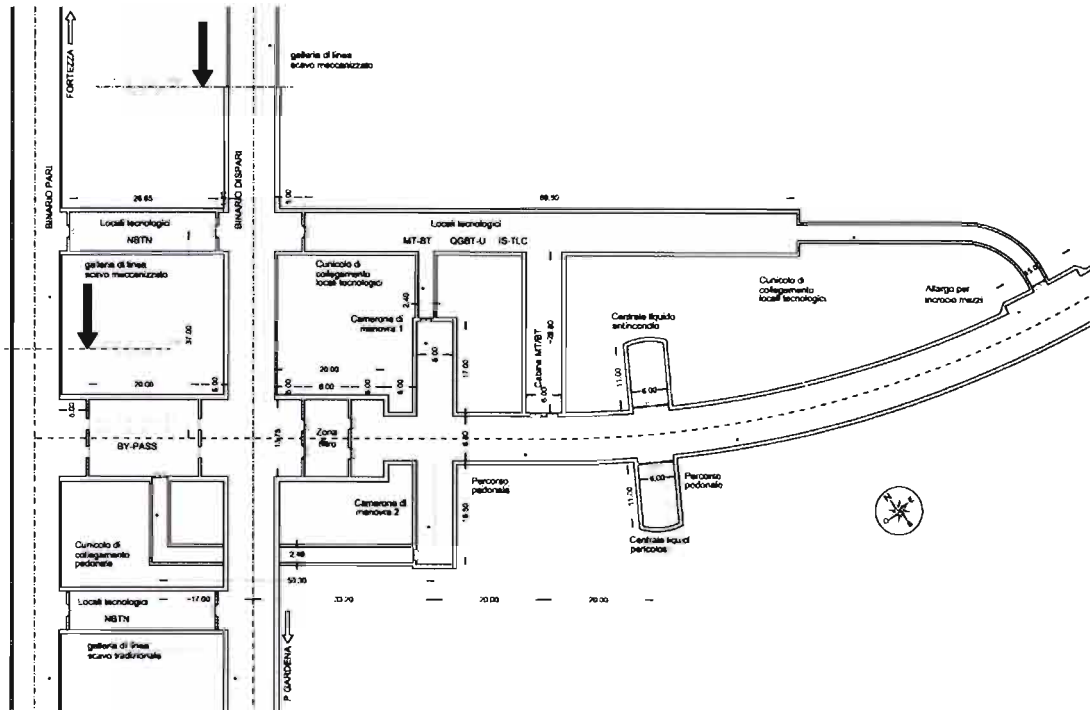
Stralcio planimetrico zona di innesto della finestra di Albes con le gallerie di linea
